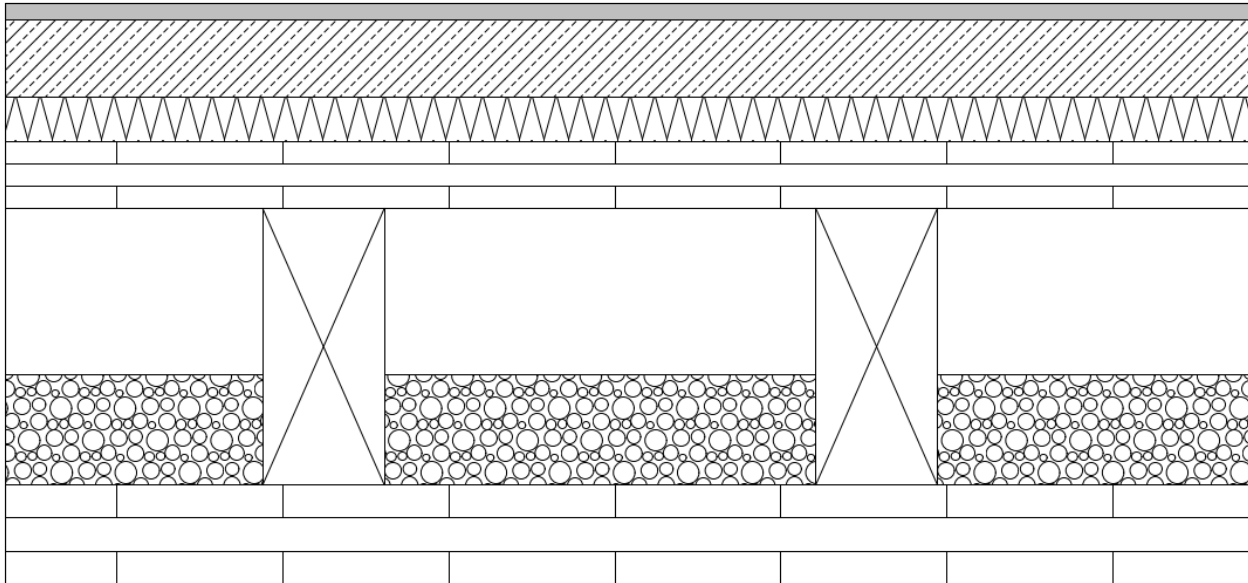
Schema einer Hohlkastendecke mit Fußbodenaufbau
